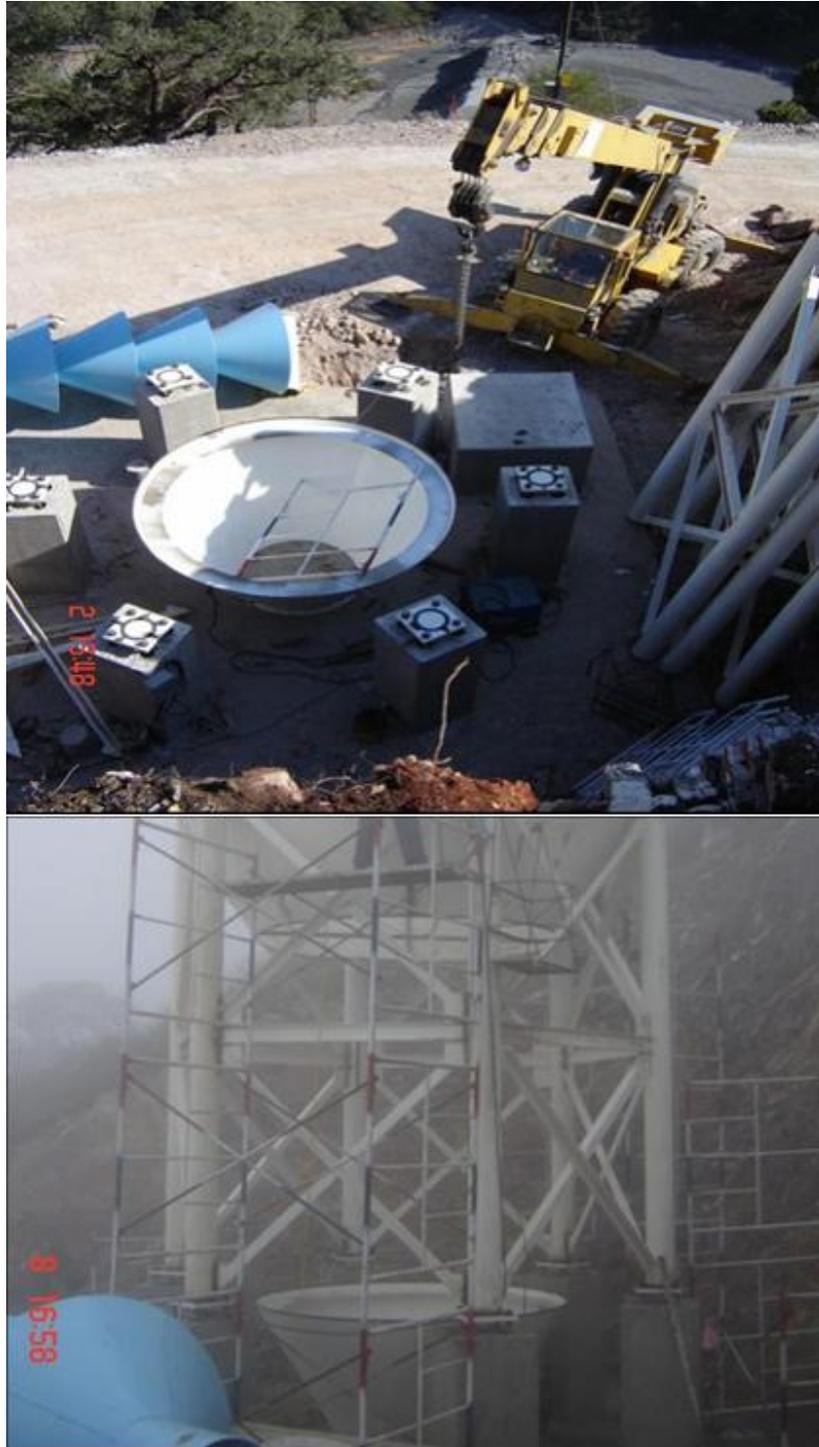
Base para el anclaje de las piernas y las piernas una vez que han sido instaladas y soldadas.
